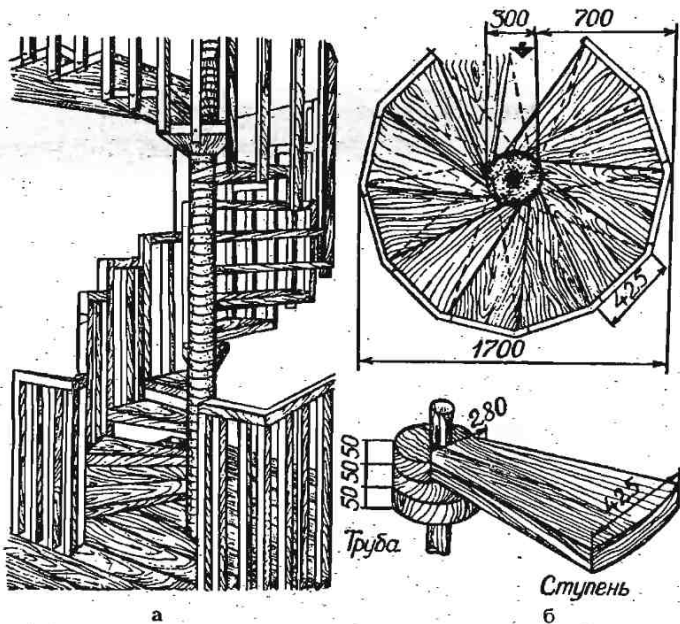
Деревянная винтовая лестница: а — внешний вид; б — крепление опорных ступеней
